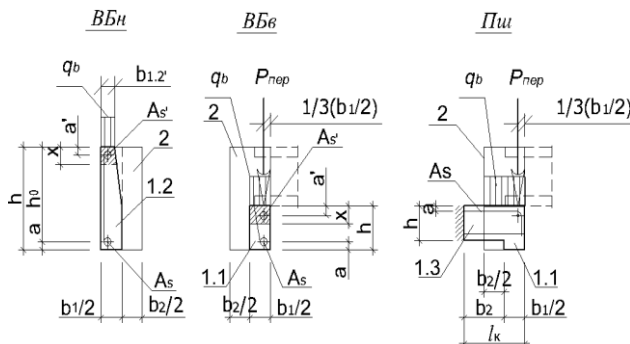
Расчетные модели сечения элементов сборного блока пояса на монтажную нагрузку: - ВБн – ветвьбалка наружная; ВБв – тоже внутренняя; - Пш - перемычка, соединяющая ветвьбалки блока; - q_b – нагрузка от сборного и монолитного бетона; - $P_{пер}$ – нагрузка от перекрытия с монтажно-технологической нагрузкой. [Разработка автора].
